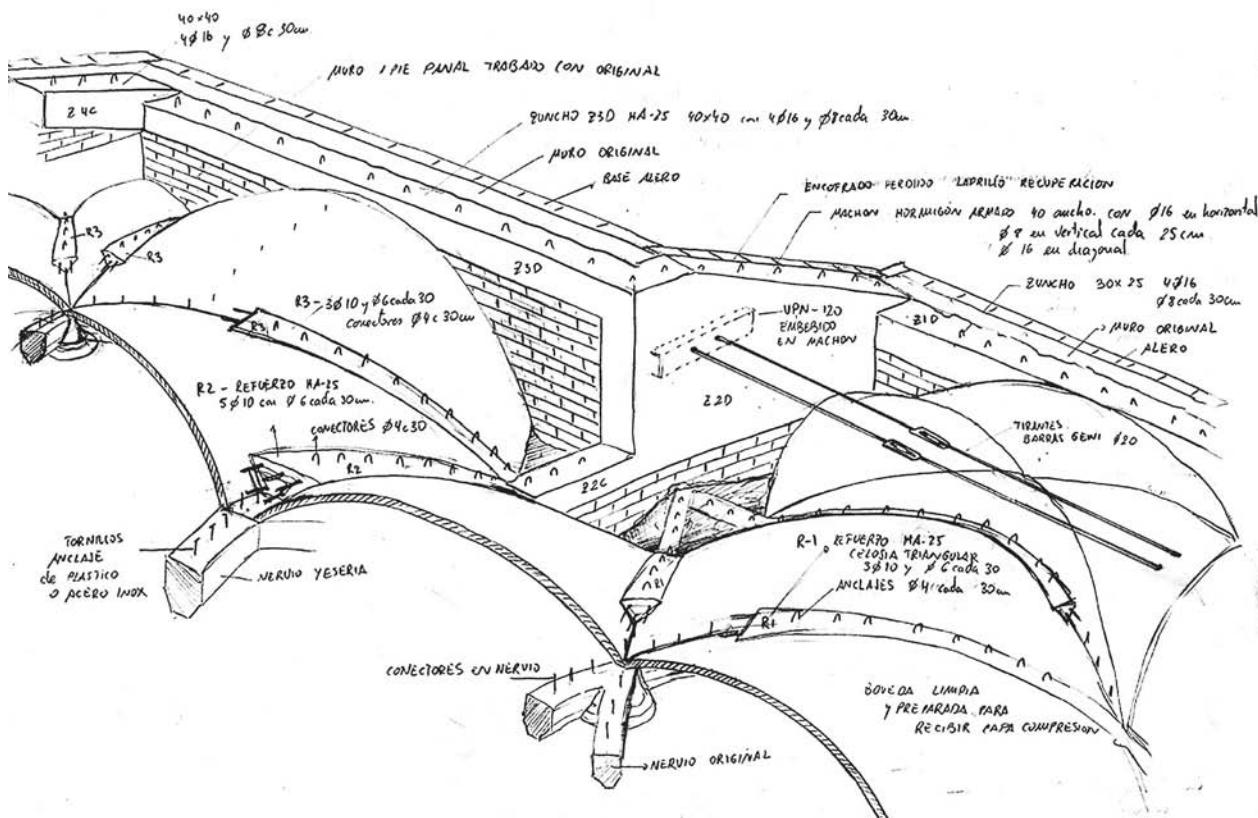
Trasdós superior de las bóvedas del ábside y primera nave. Esquema estructural de cubierta
